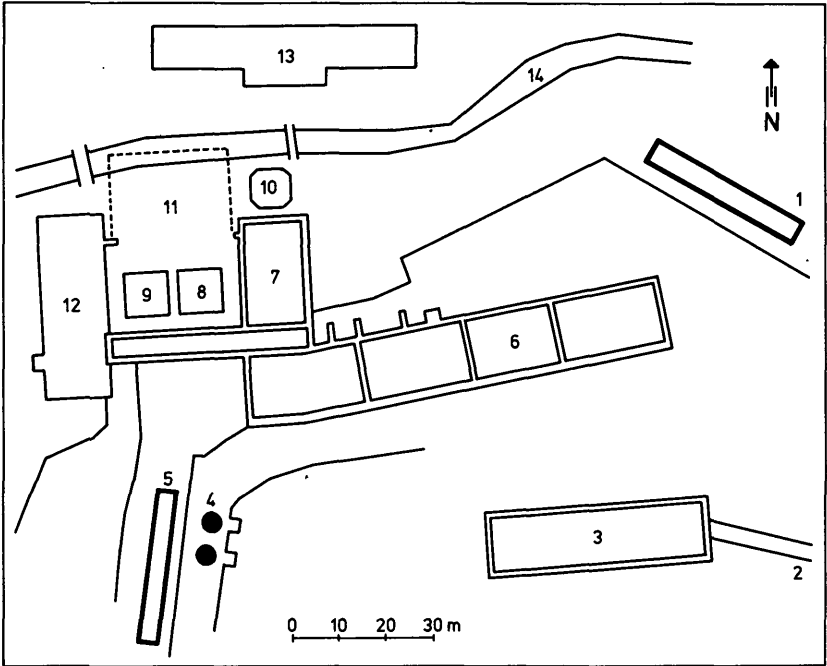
Lageplan des Eisenwerkes Heft. Vereinfachte Wiedergabe (Ausschnitt) eines von H. SCHENN, Knappenberg, aufgenommenen Planes (mit Ergänzungen von H. J. KÖSTLER).
